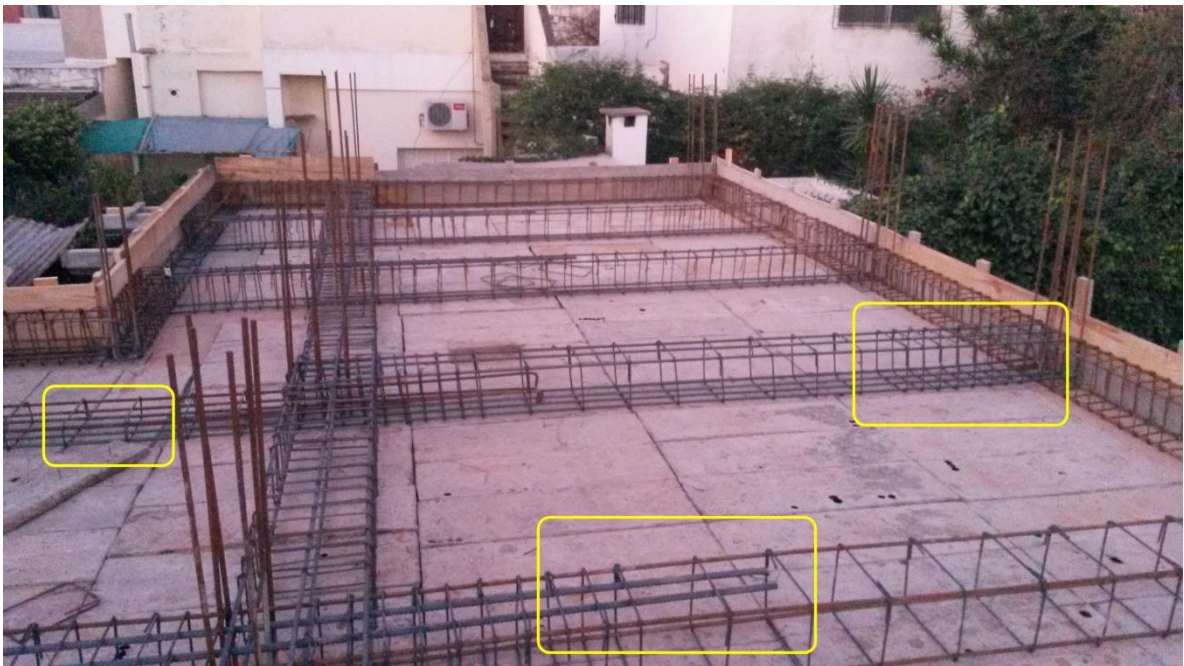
Imagen panorámica del encofrado de losa sobre planta baja
